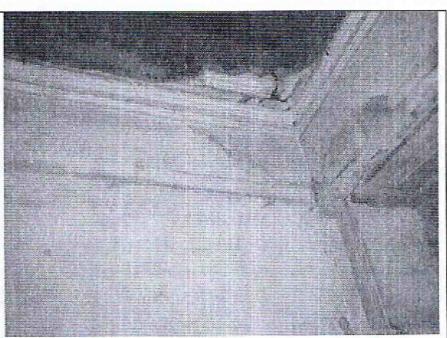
Grieta en parte alta de muro de segundo nivel.
